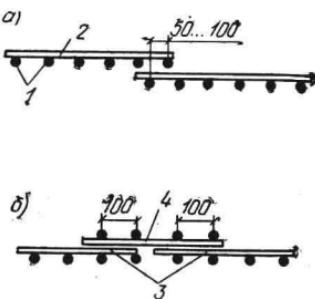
Стыки сварных сеток в направлении распределительных стержней, выполненные без сварки
